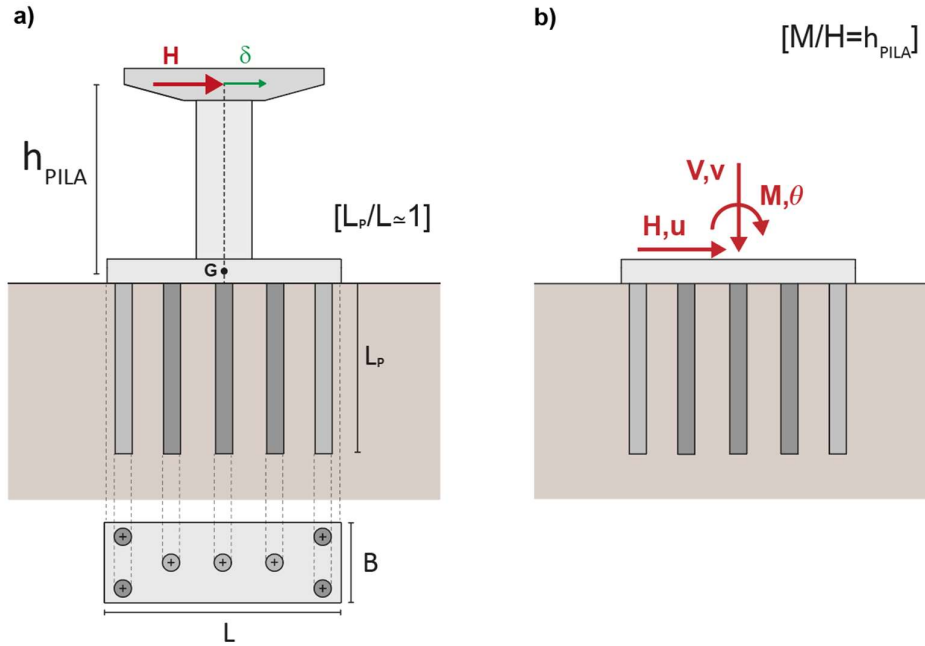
Pila tipica di viadotto costruito negli anni '60: (a) geometria e (b) schema carichi in fondazione.
